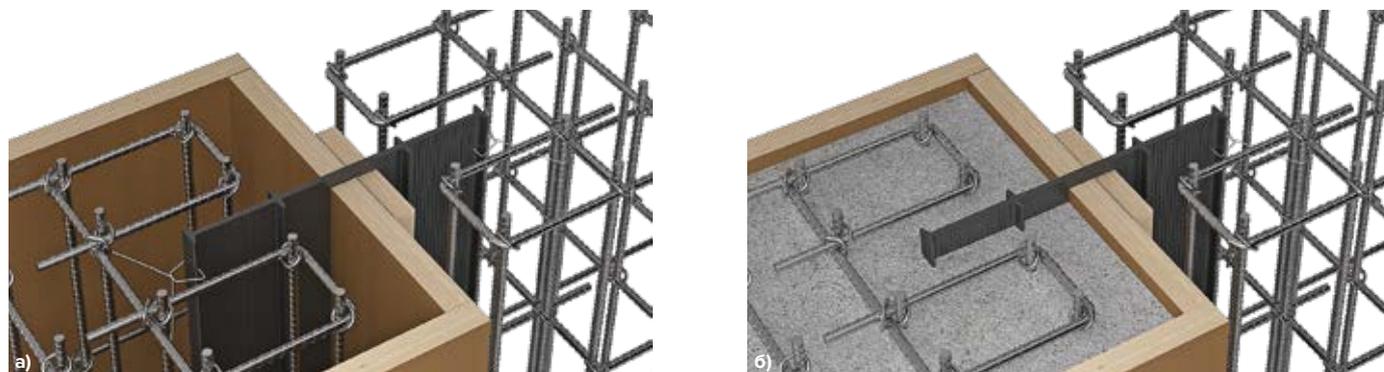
а,б. Этапы работ по установке гидрошпонок серии ТН Фундамент ДШВ
